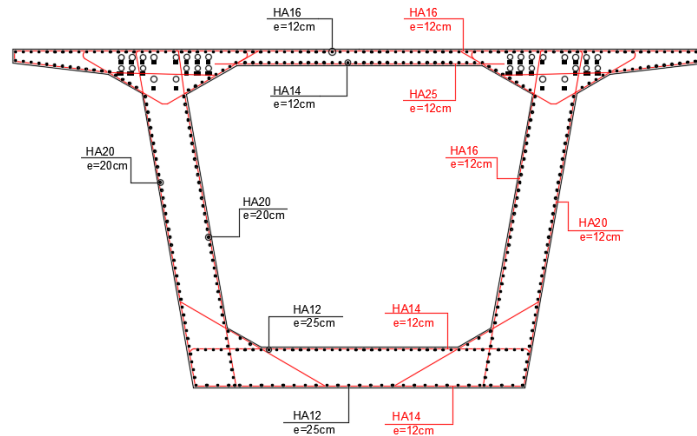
Ferrailage du voussoir sur pile.
